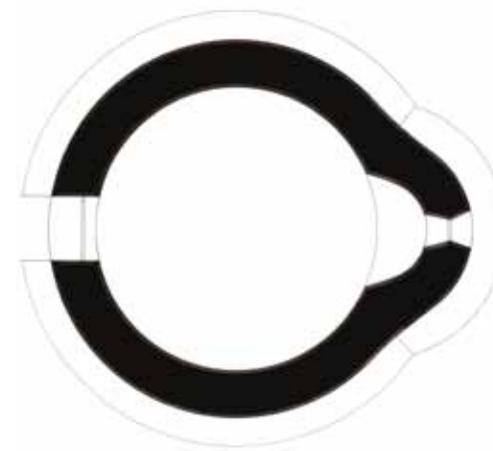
Grundriss St. Georgen ob Murau, M 1:200. BDA Planarchiv Wien.
